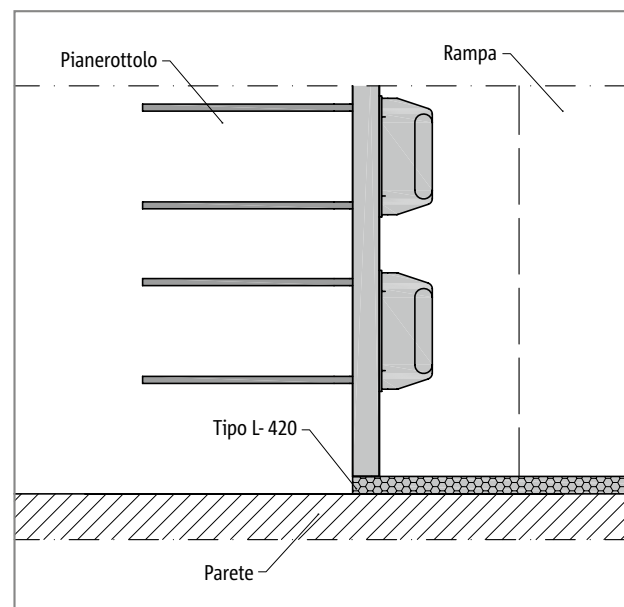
Schöck Tronsole® tipo T, disposizione dell'elemento; dettaglio B
